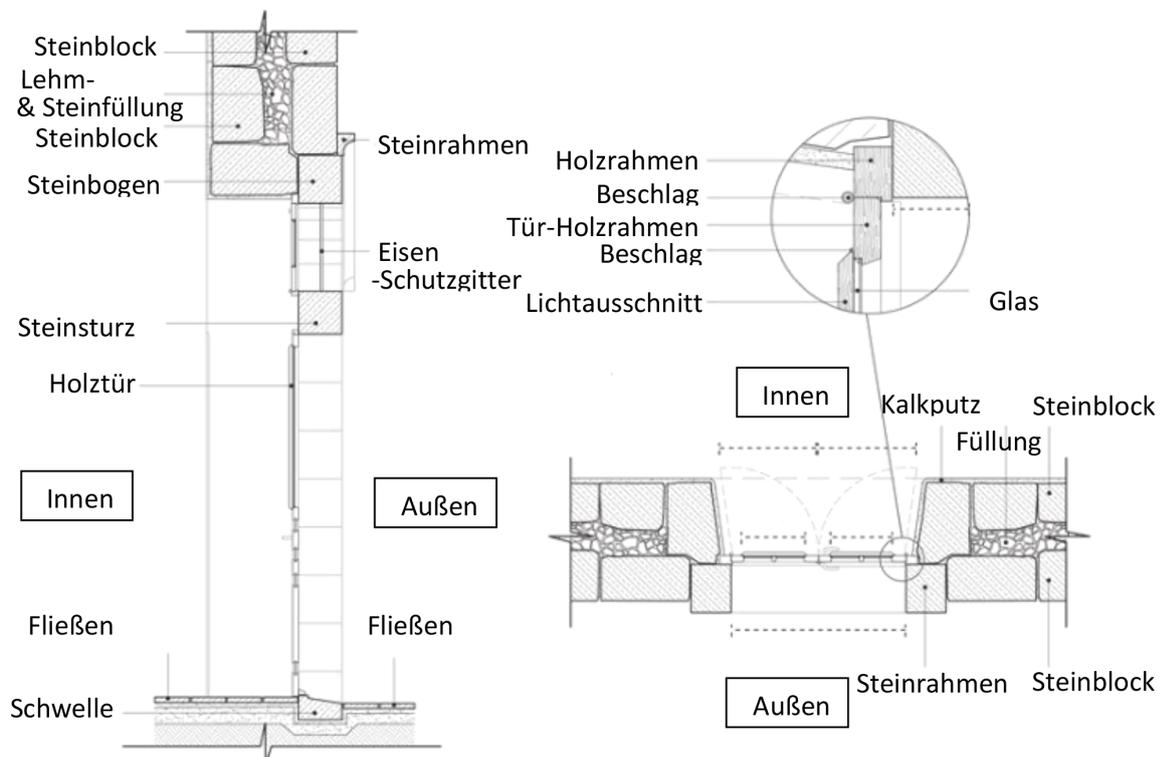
traditionelle Tür-Ausführungsdetail- Schnitt & Grundriss
